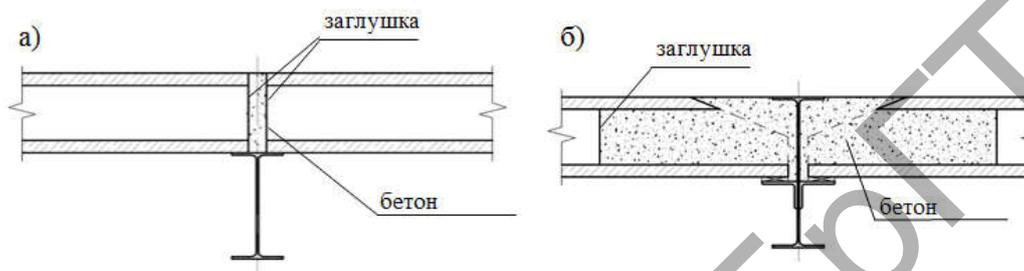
Узел опирания сборной железобетонной плиты на средний ригель:
